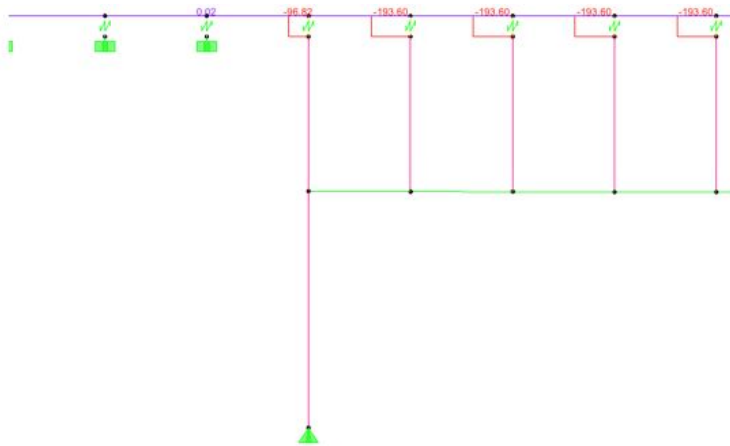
Viaducto de Nervión. Detalle en zona de estribo 1. Reacciones verticales en zona de estribo
